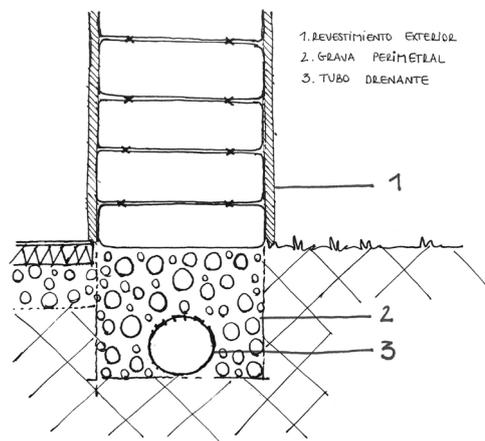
Detalle de cimentación con zanja de grava. Elaboración propia
